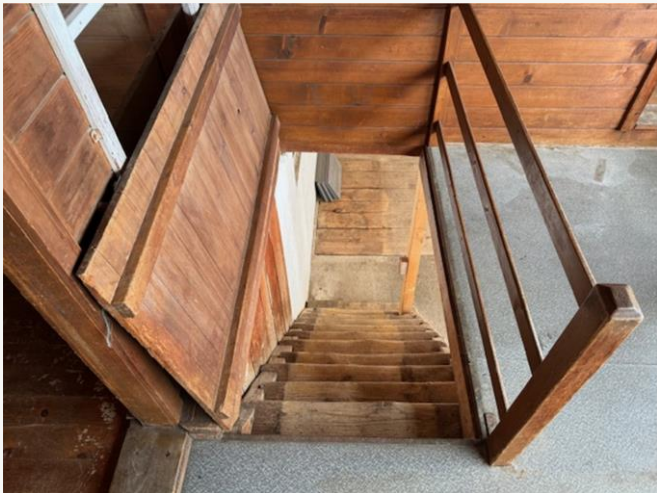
FOTOS OBERGESCHOSS / ZIMMER NEBEN LAUBE
